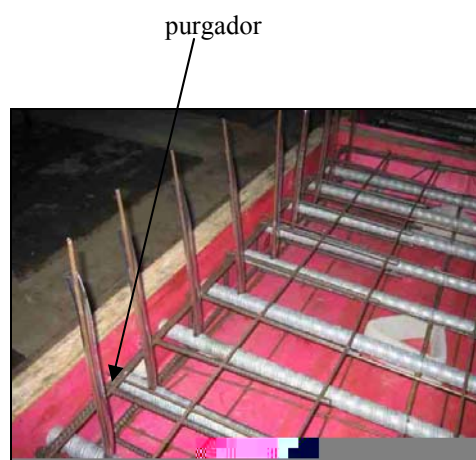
COLOCAÇÃO DE PURGADORES
